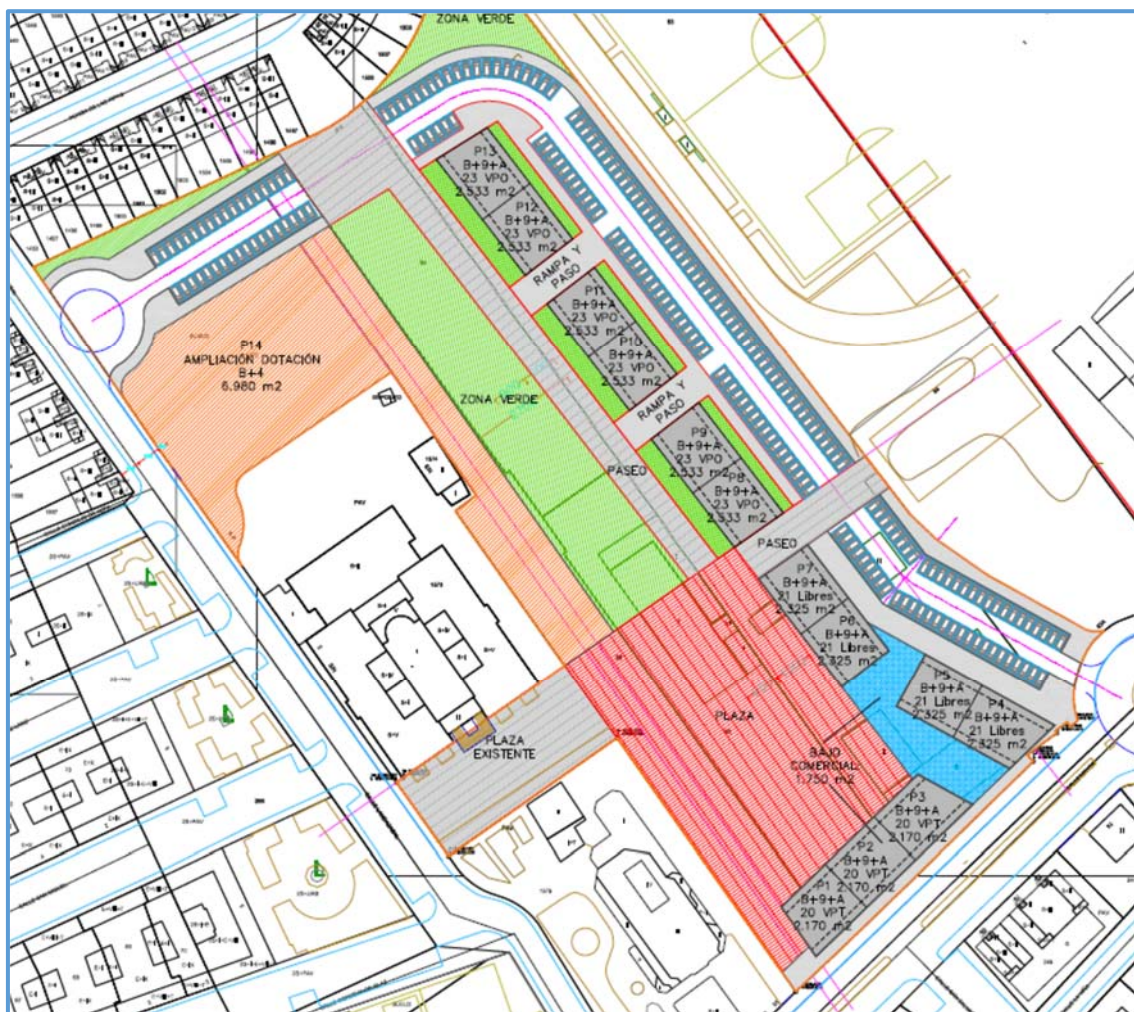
Planta PEAU APD-R2 en Burlada.
